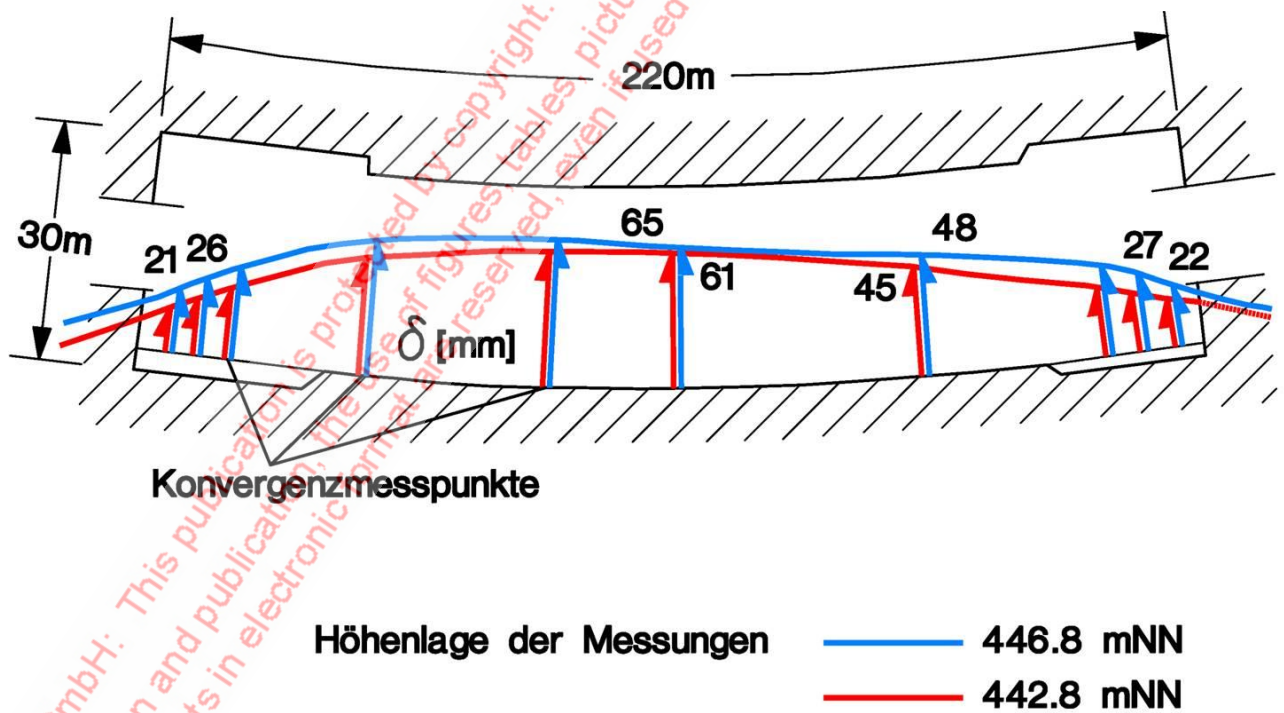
Baugrube Haltestelle Universität, Horizontalverschiebungen
